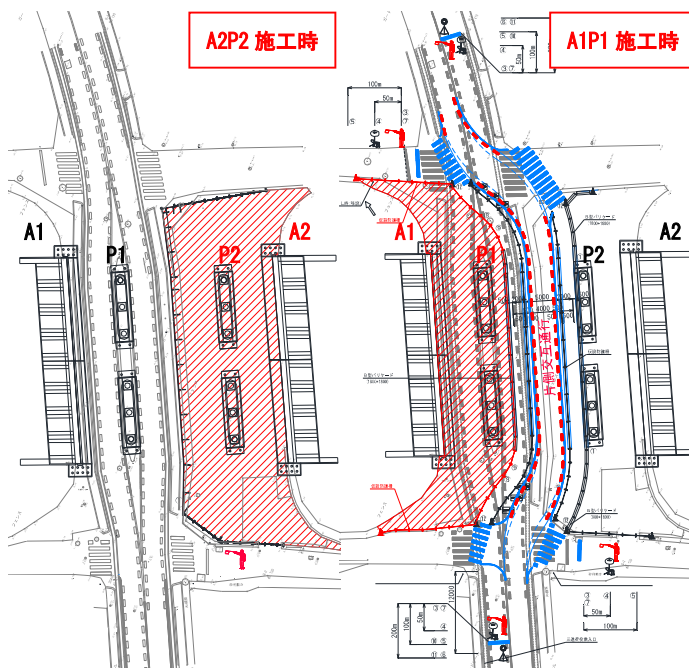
市道平面図(切回し前) 図-6 市道平面図(切回し後)
